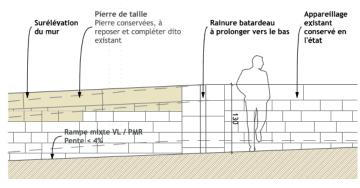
Détail de la réhausse du mur parapet le long de la rampe
